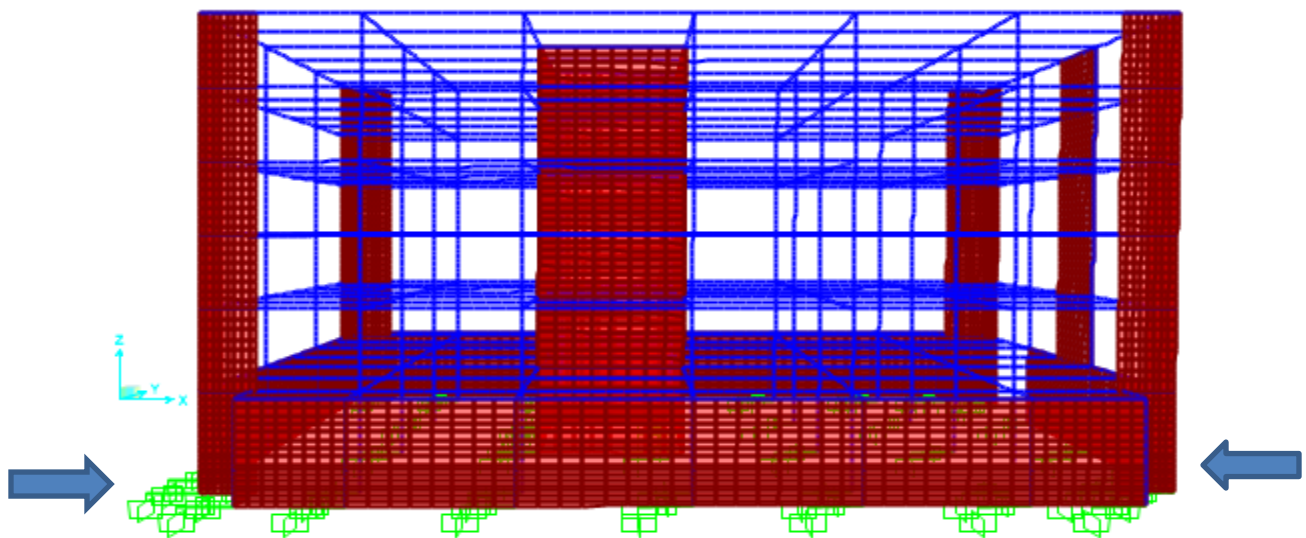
Segundo modo traslacional en Y de la estructura aislada con un sistema mixto de aisladores sísmicos HDR+LRB
